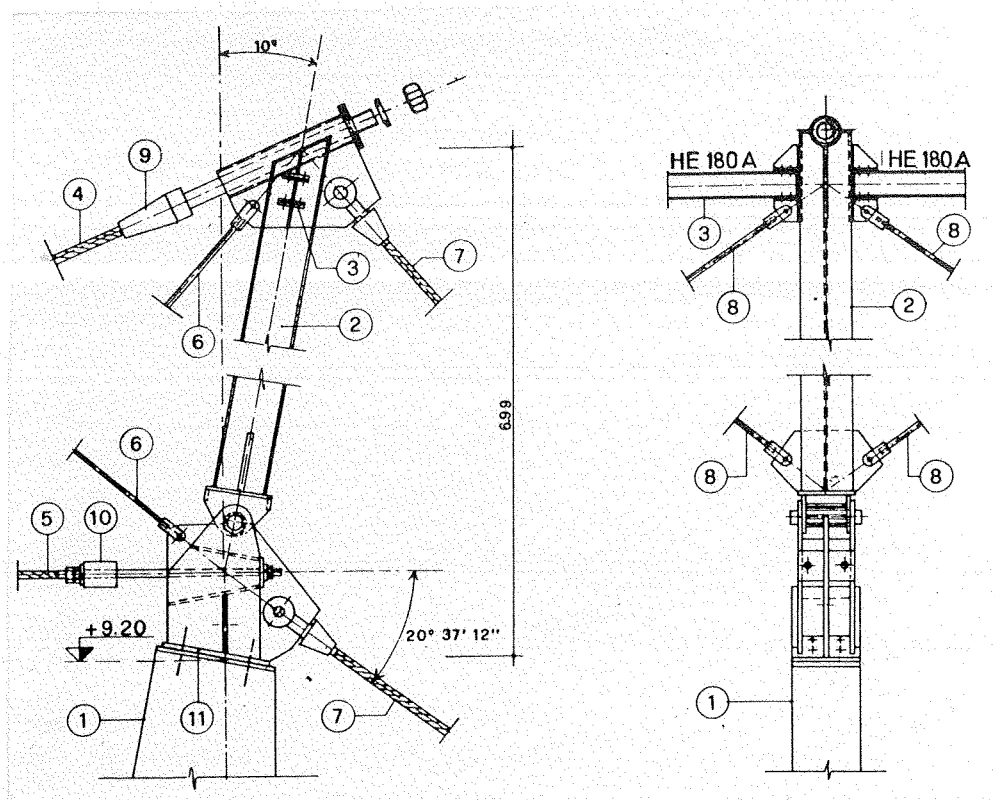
Dispositivo pré-fabricado para a fixação dos cabos e tirantes. 1) Pilar em concreto; 2) Montante; 3) Perfilado de ligação; 4) Cabo portante; 5) Cabo tensor; 6) Diagonais; 7) Tirantes externos; 8) Contraventamento vertical entre montantes; 9) e 10) Arranques dos cabos; 11) Placas.
